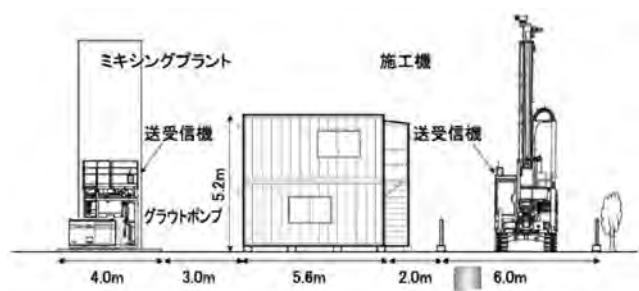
に試験施工状況を、図-8に機械配置を示す。使用した機械は一般的な地盤改良工事で用いられている油圧駆動式の地盤改良施工機、グラウトポンプ、ミキシングプラントで、本システムによる制御を適用した。試験施工に際しては電波環境が厳しい住宅地を想定し、送受信機を搭載したミキシングプラントと施工機の間に2階建て相当の小規模建築物を仮設した。
